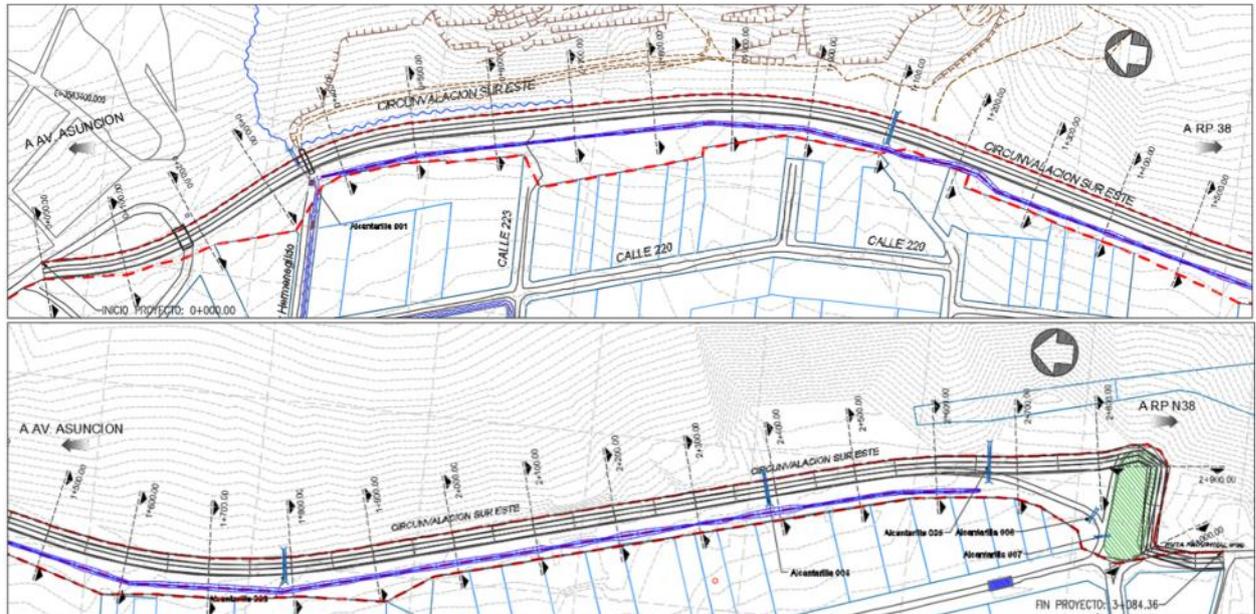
Planimetría Cunetas Proyectadas Av. de Circunvalación
